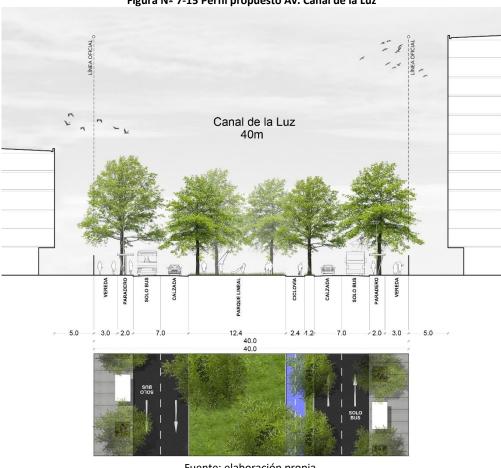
Perfil propuesto Av. Canal de la Luz
